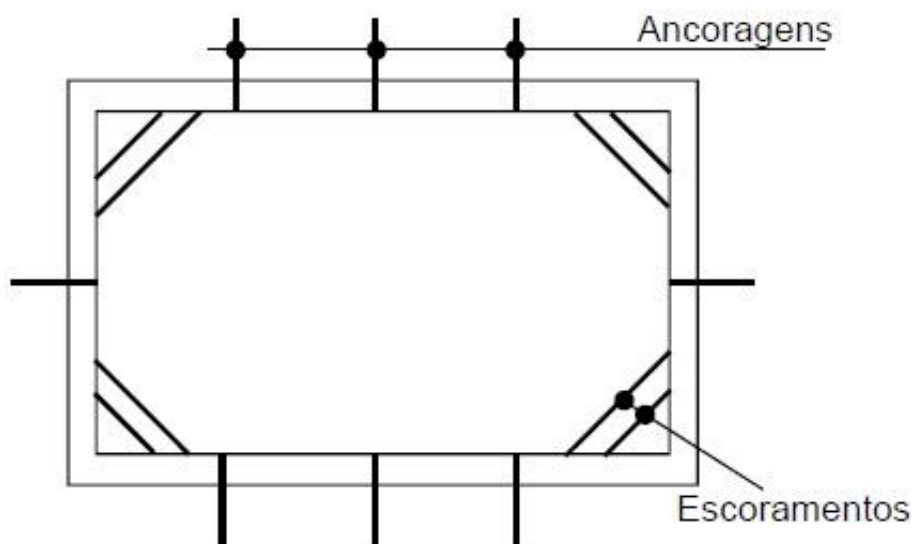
Planta de ancoragens e escoramentos no suporte auxiliar de uma parede tipo Berlim
